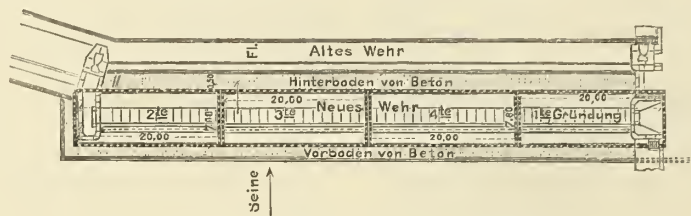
Grundriss des Wehrs von Condray.
